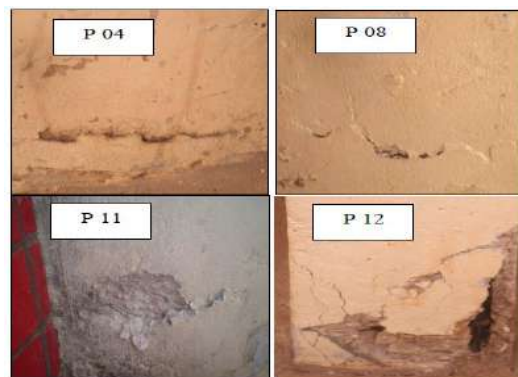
Pilares com aberturas e deslocamento do concreto.
